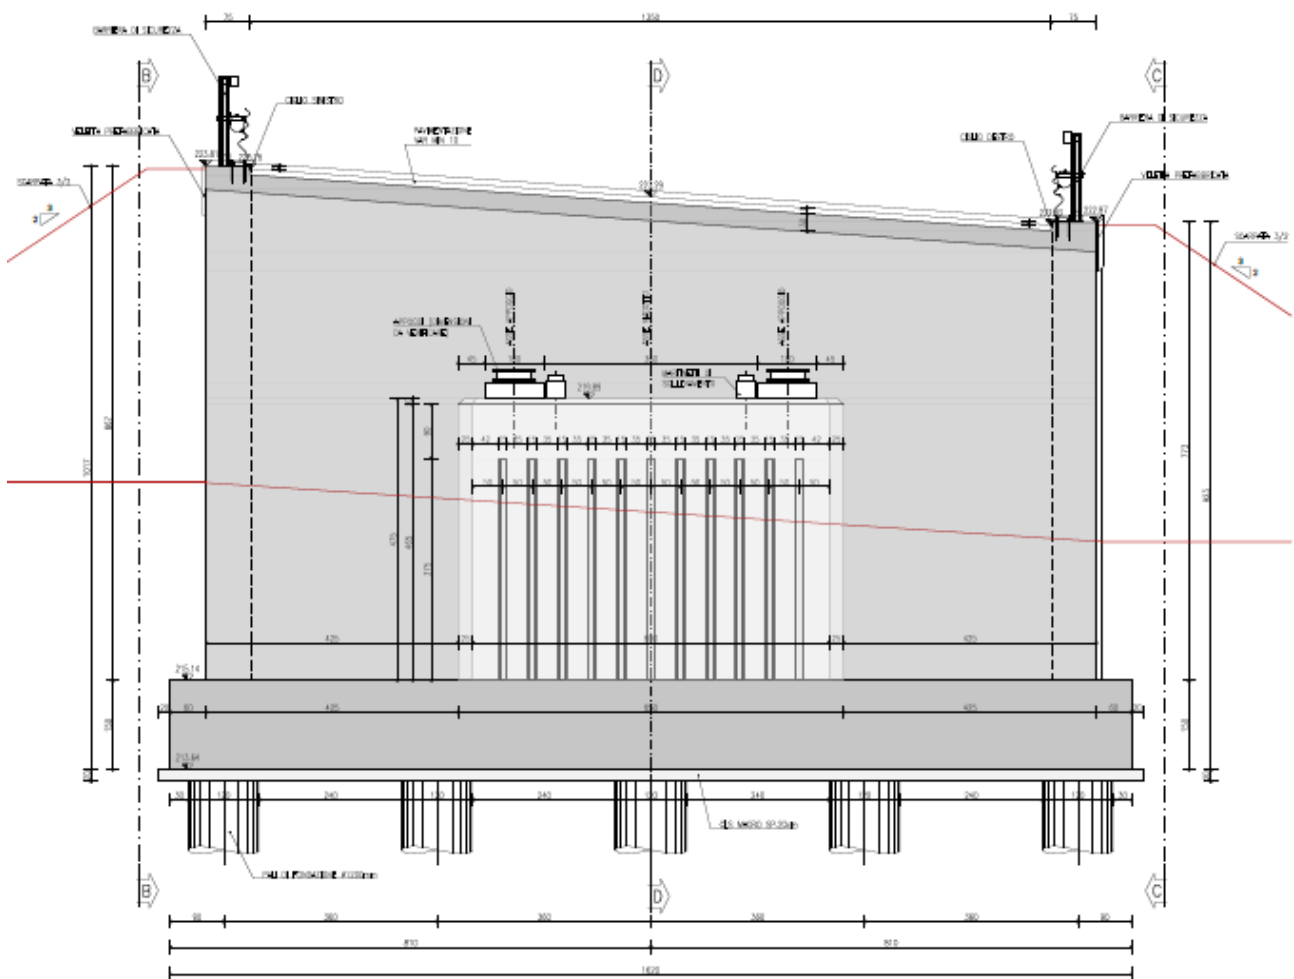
Spalla 2 – carpenteria elevazioni
